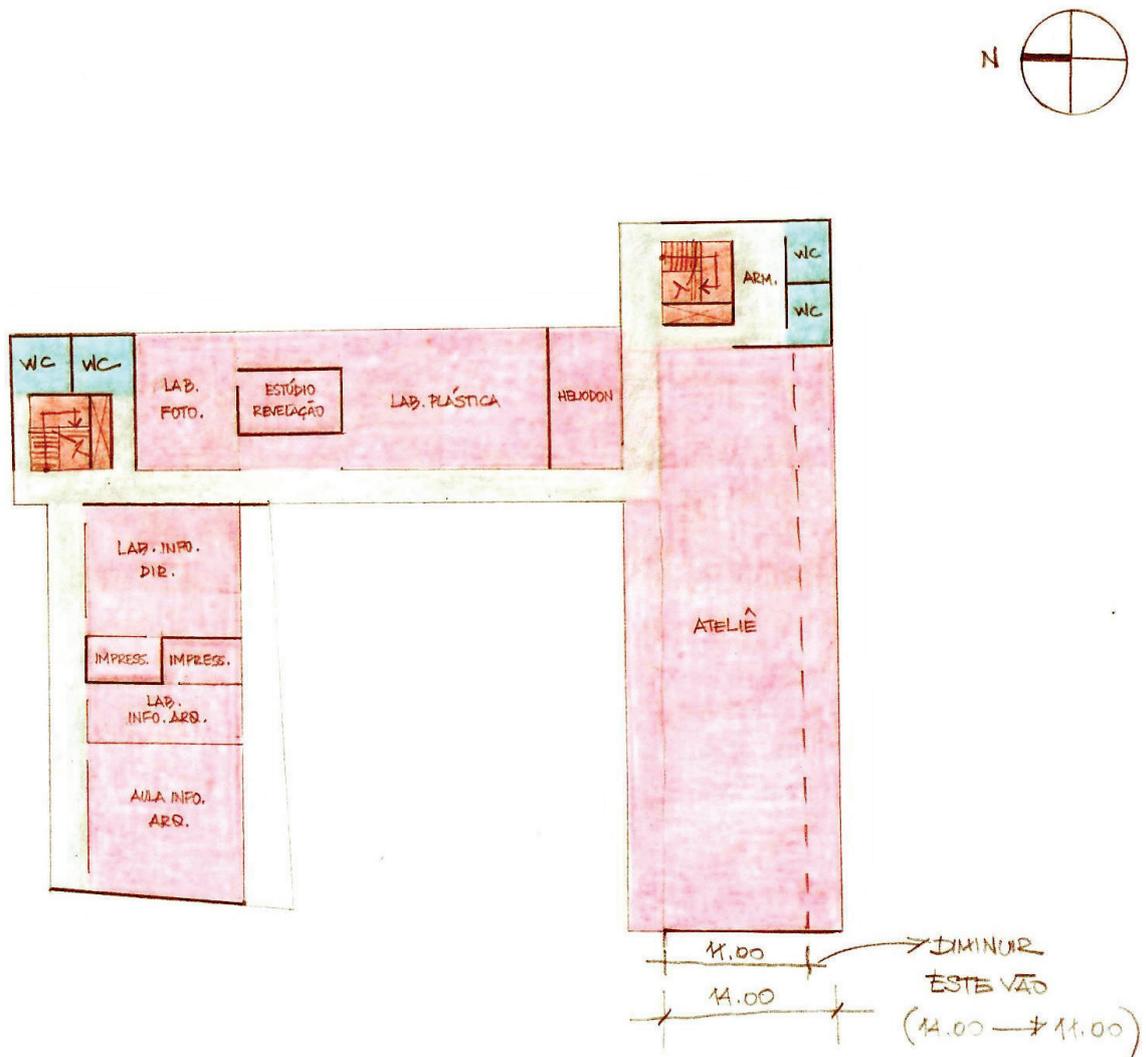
Proposta 4, estudo preliminar, Planta do 2º Pavimento
